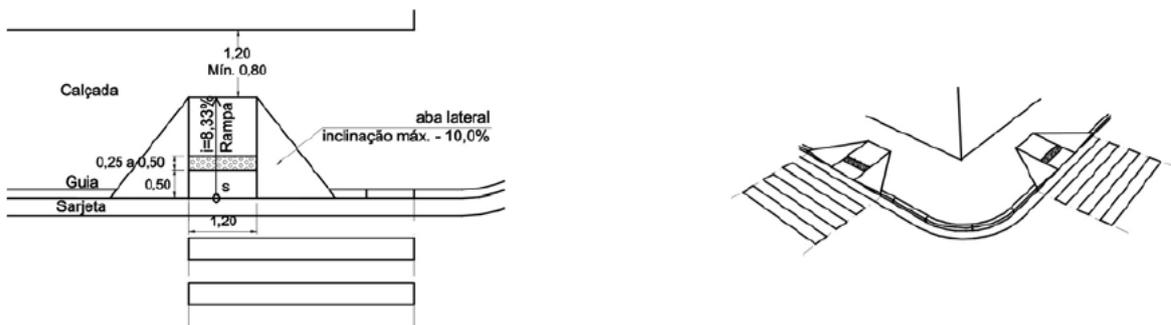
Tipo 1 de rebaixamento da calçada – passeios largos.
